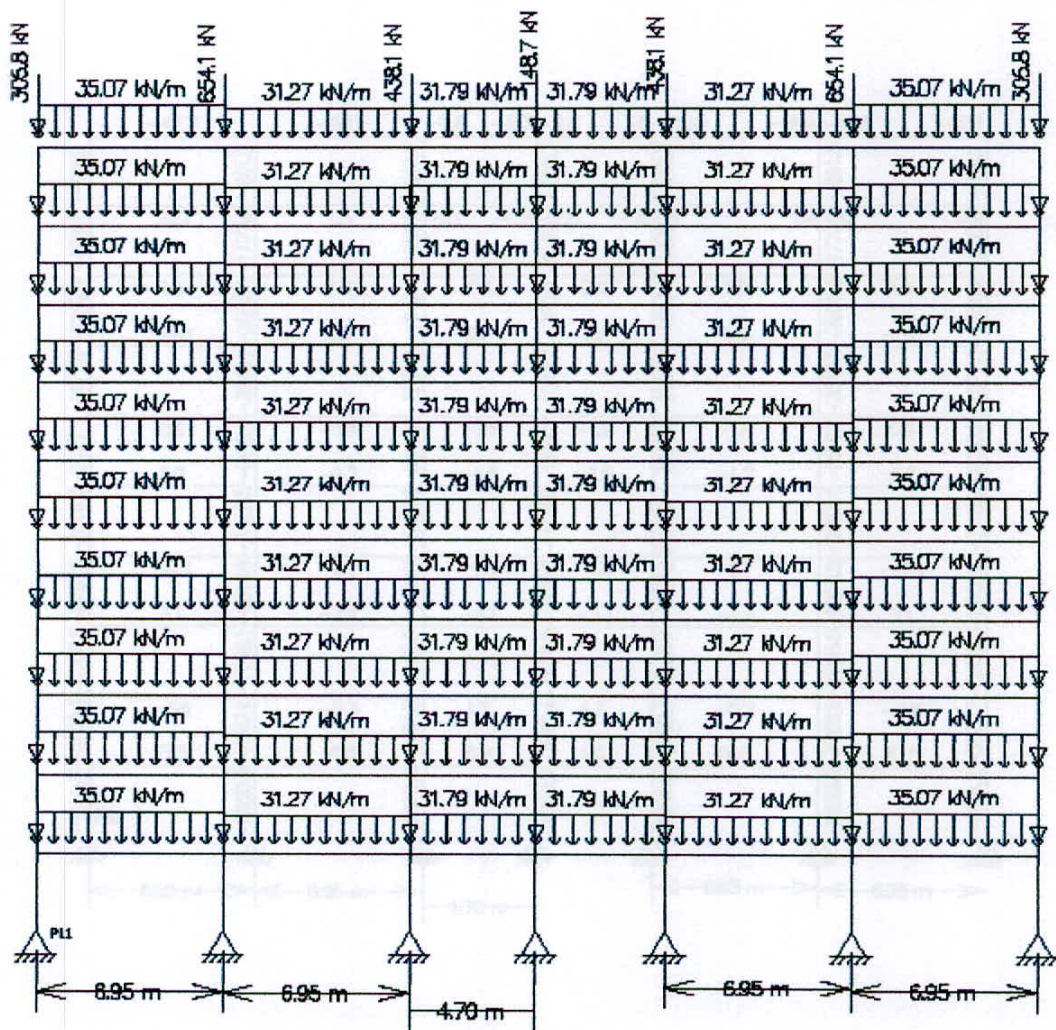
Pórtico P11 longitudinal, carregamentos finais.
